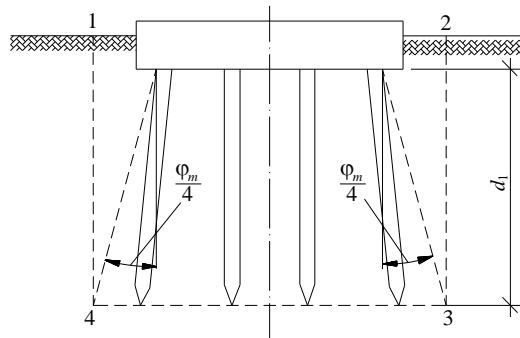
Условный свайный фундамент с ростверком, заглубленным в грунт, при угле наклона свай менее $\varphi_m/4$
